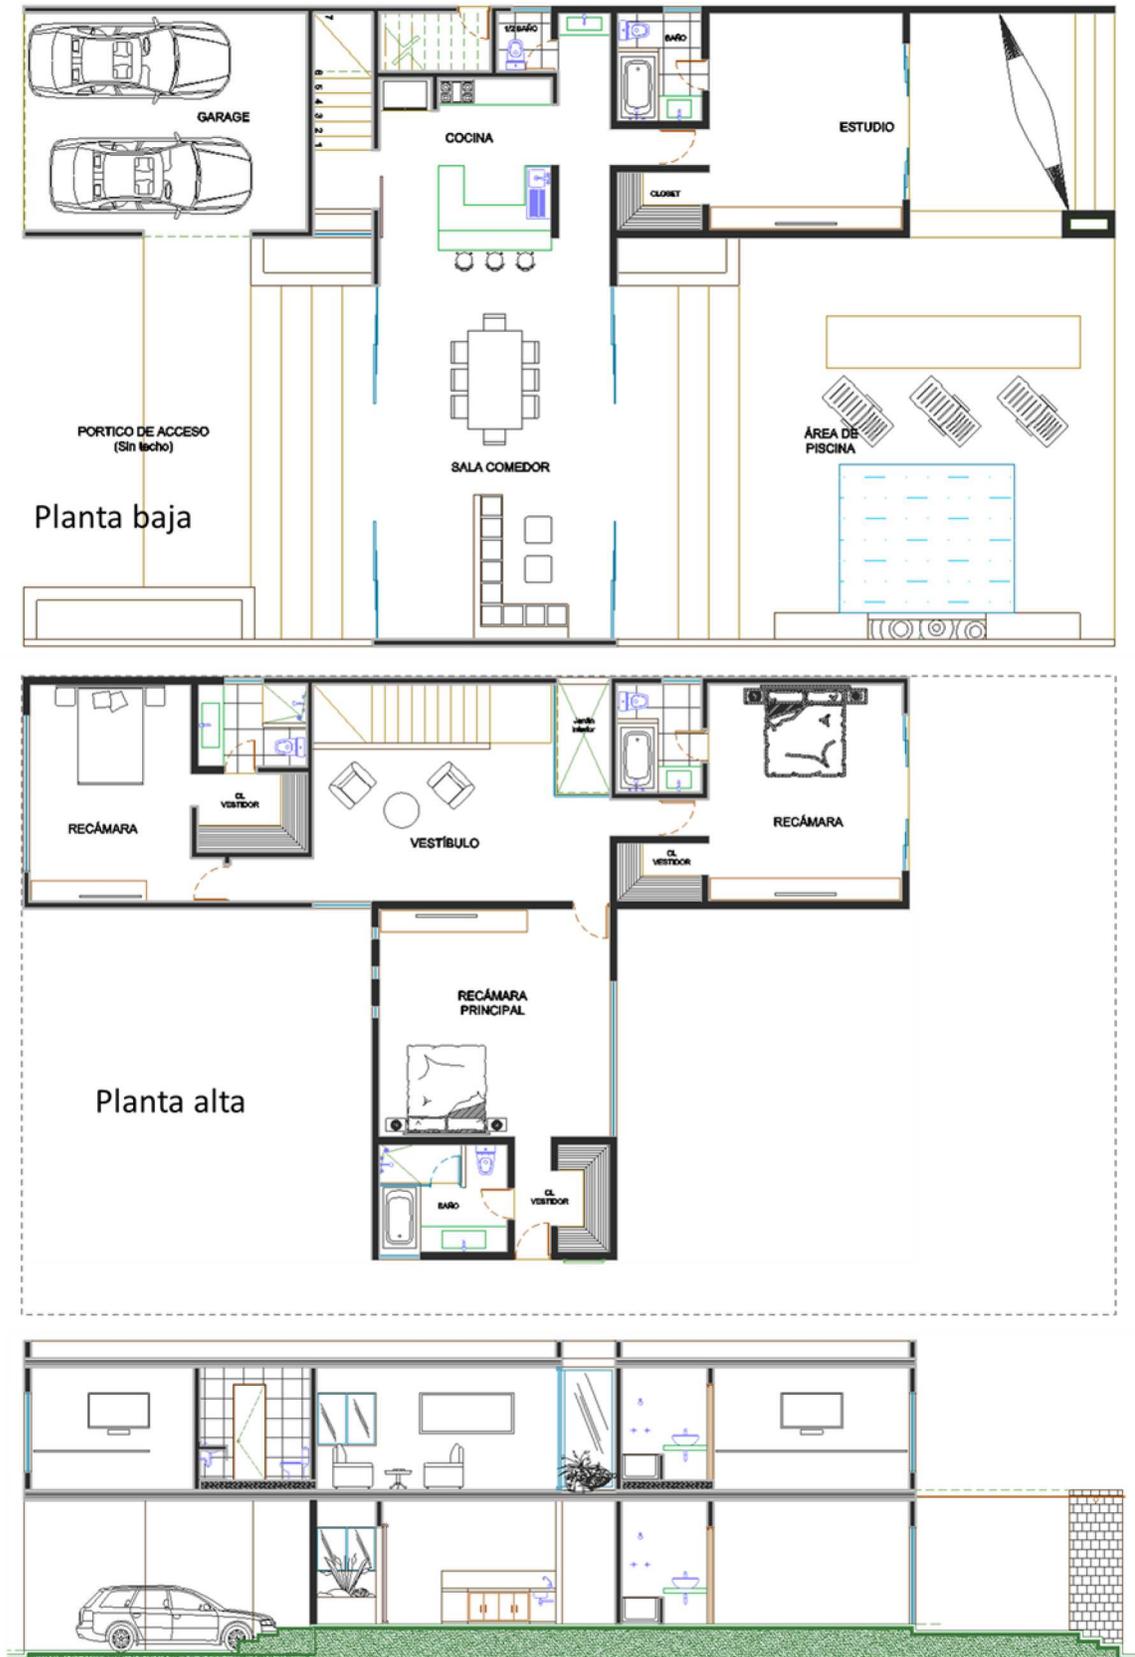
Vistas de plantas y corte longitudinal del proyecto Casa Paula.
